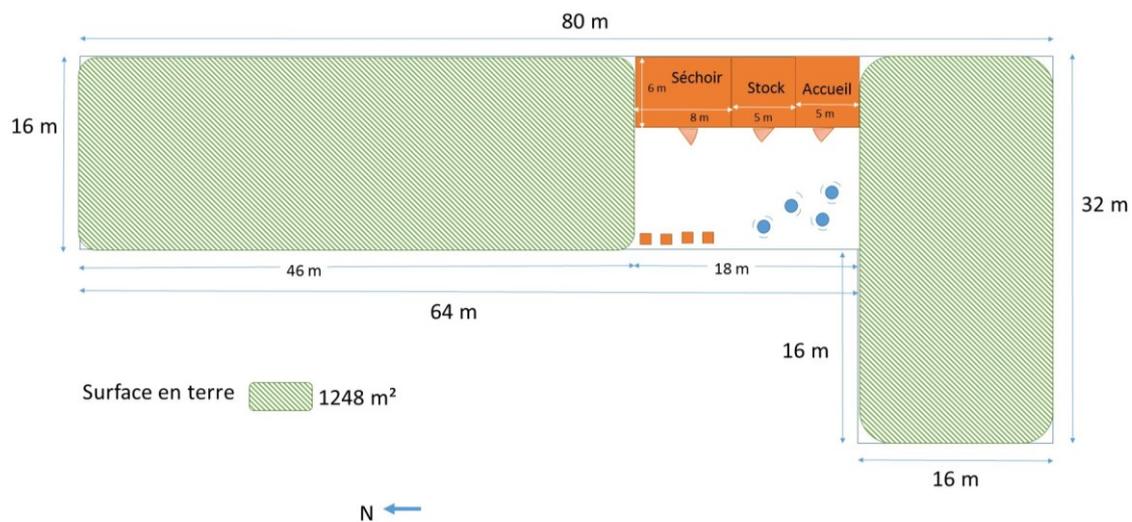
Plan d'aménagement E6 sans serre (Brieuc CORNET)
